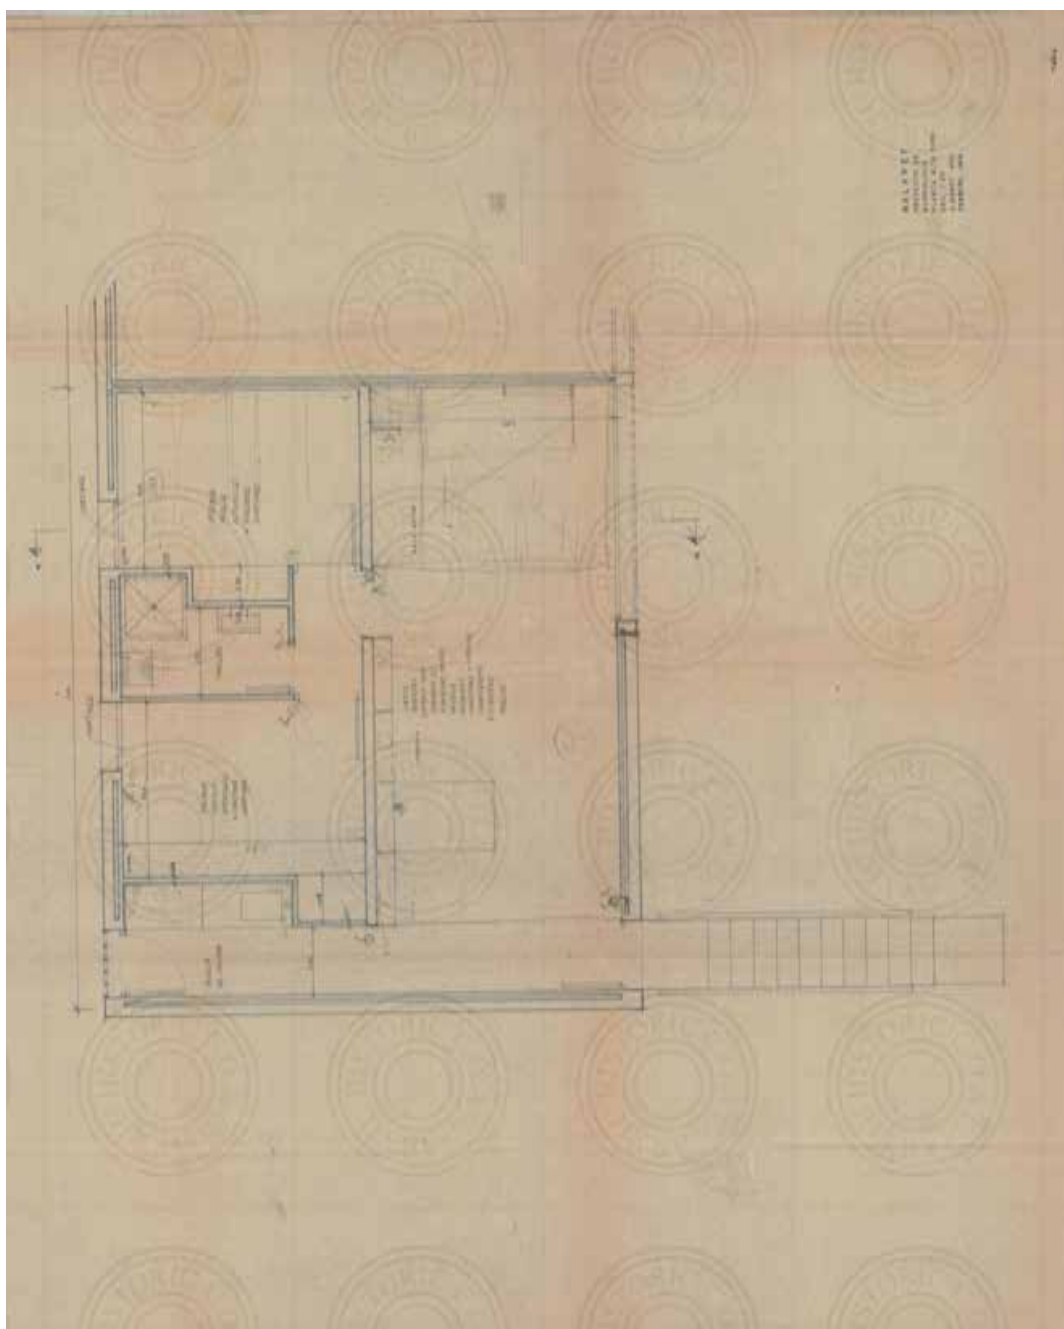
Plano del proyecto original del conjunto Maralet. Planta de una vivienda tipo. Escala original 1/20. Fecha febrero de 1964. Fuente: Arxiu Historic COAC
